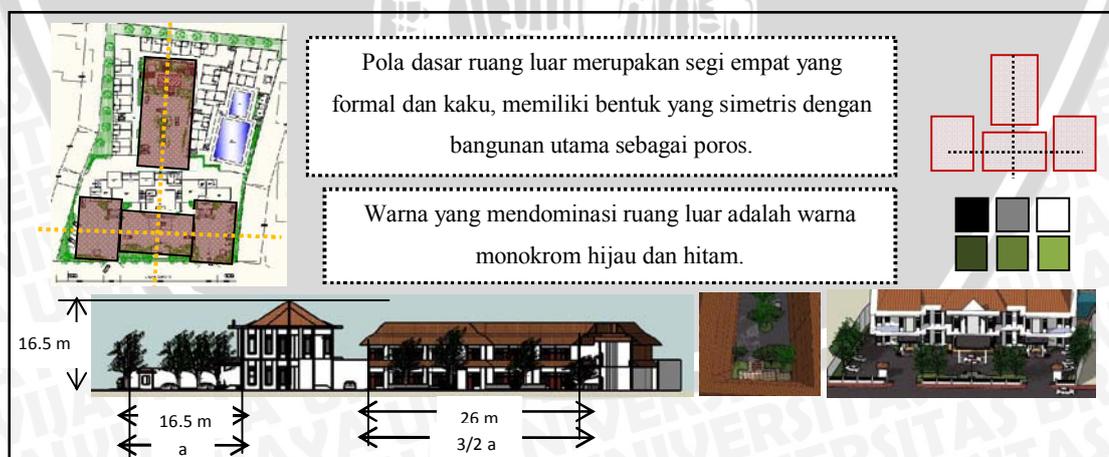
Hirarki ruang luar pada alternatif 1
